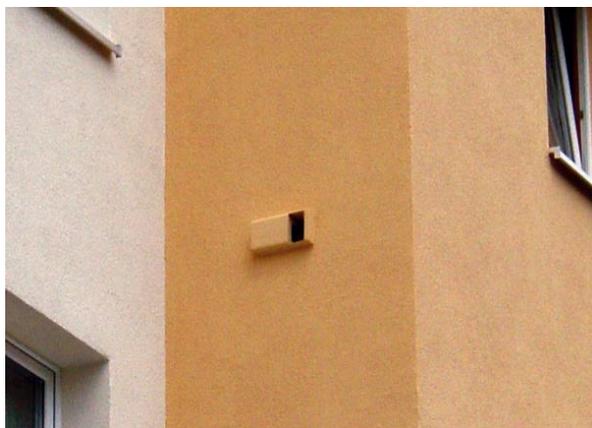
Fassaden-Einbaukasten 1HE, Einbaubeispiel Fassade (Quelle: www.schwegler-natur.de)
